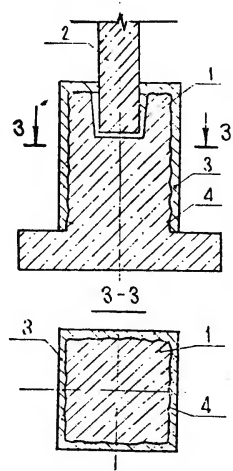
Устройство обоймы из фибробетона на стаканную часть фундамента
